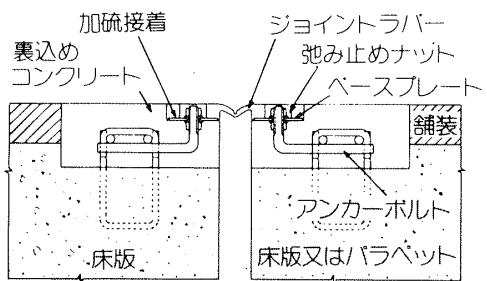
ニューエスビーラバージョイント¹⁰²⁾
